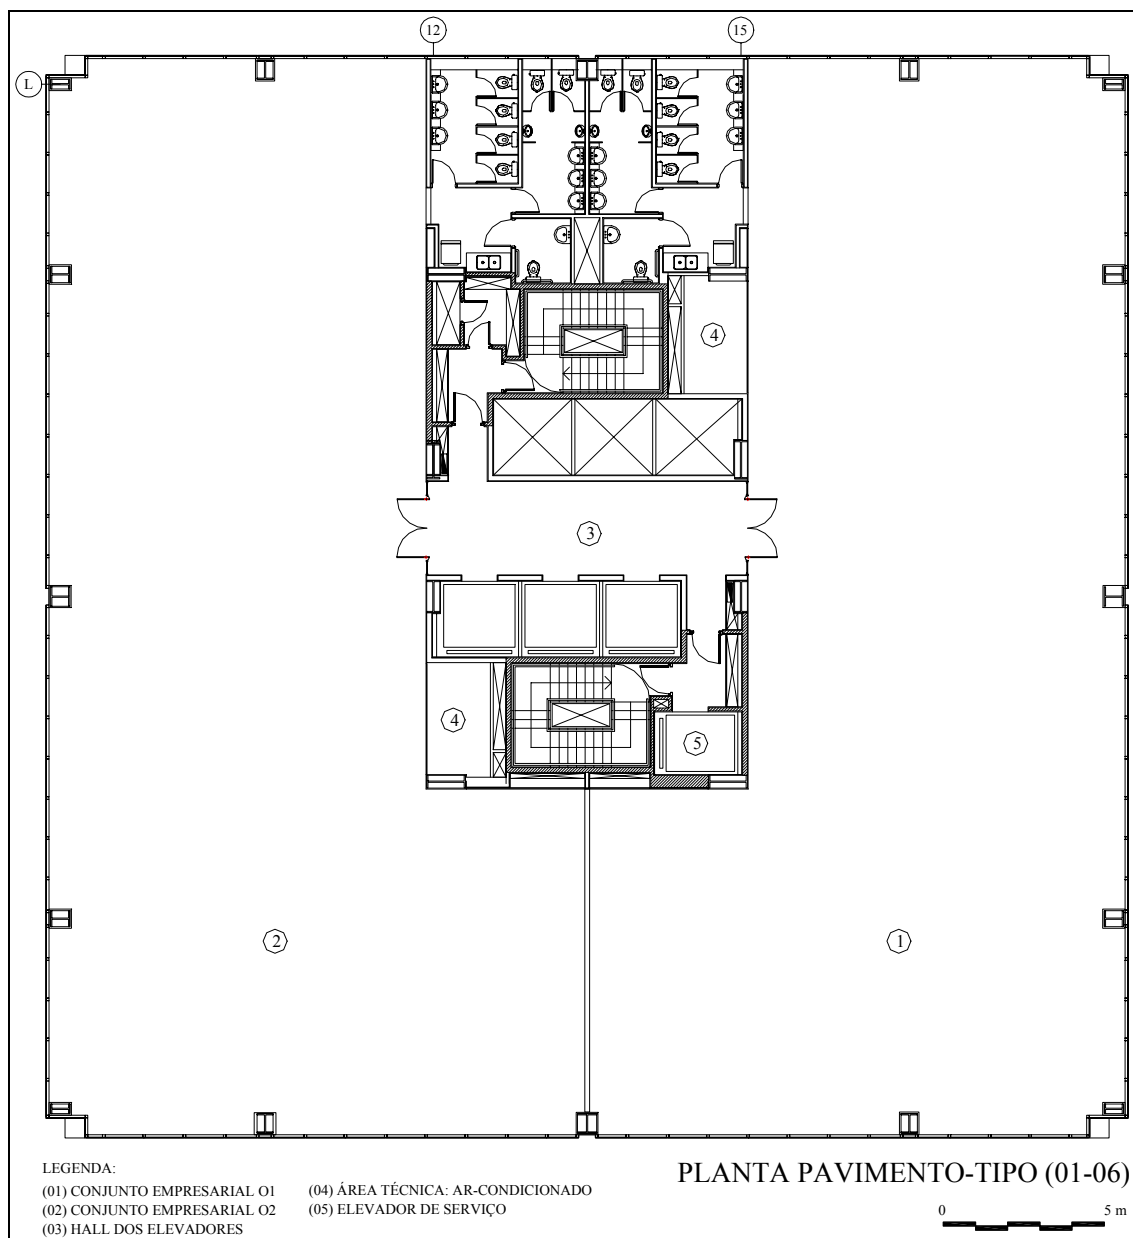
Solução arquitetônica do E-2: esboço da planta dos pavimentos-tipo, do 1º ao 6º andar.
